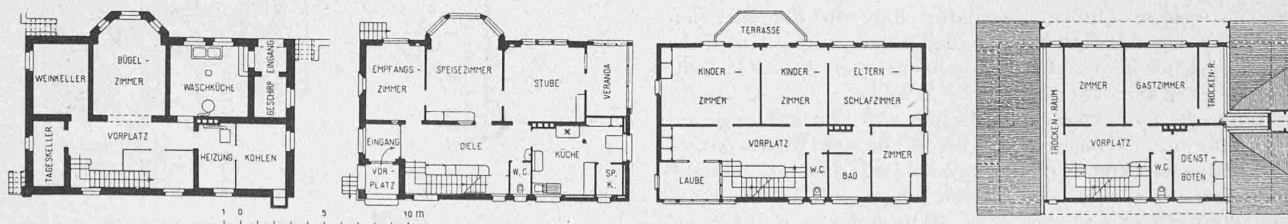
bis 4. Grundrisse vom Keller, Erdgeschoss, I. Stock und Dachstock des Hauses Zürcher in Teufen. — Masstab 1 : 400.
